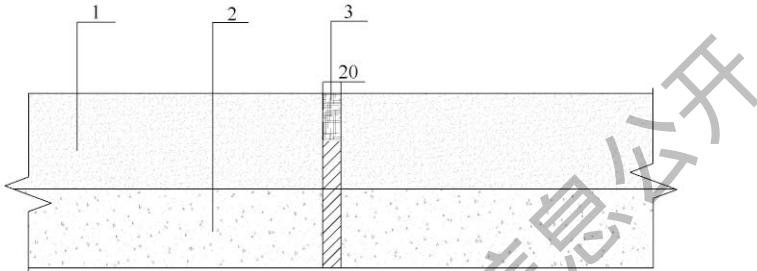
半透水水泥混凝土路面胀缝构造 (单位: mm)
